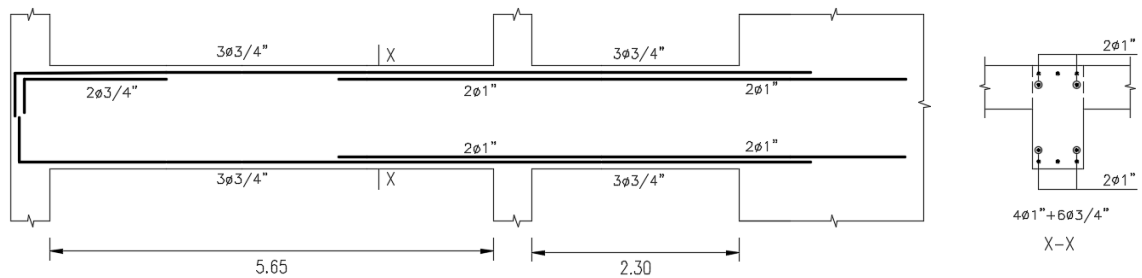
Acero corrido y de refuerzo colocado en la viga VT-02
